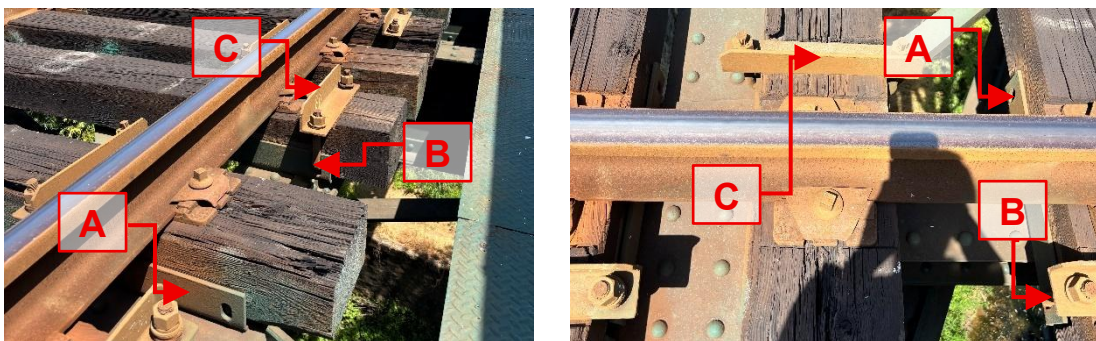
Ponte de Alferrarede, Fixação das Travessas à estrutura
